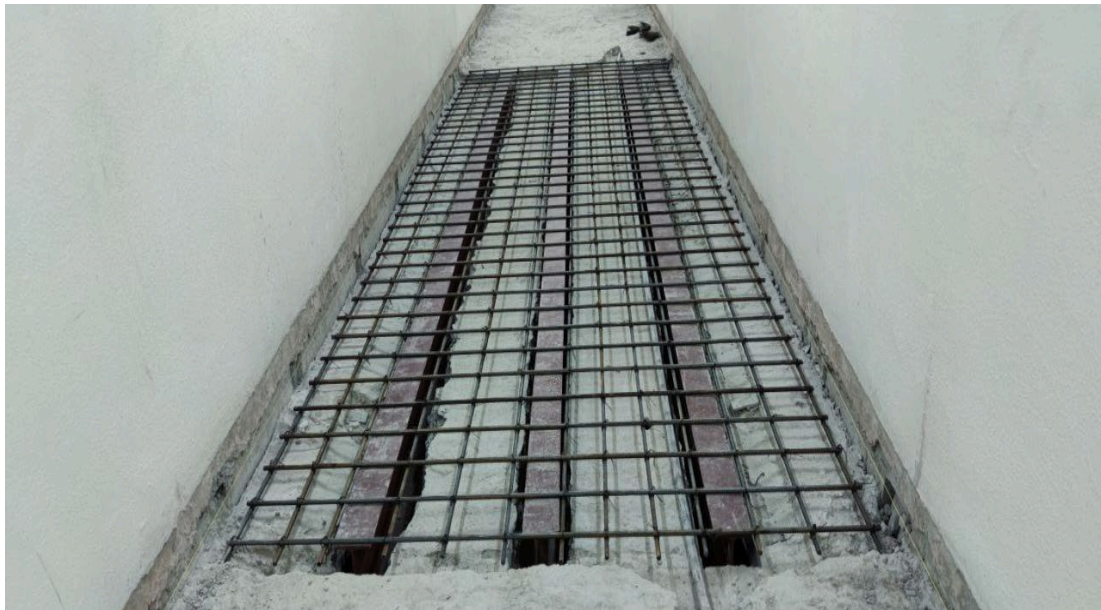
Влаштування елементів підсилення плити металевими балками та армованої фібробетоною плитою по верх них.
